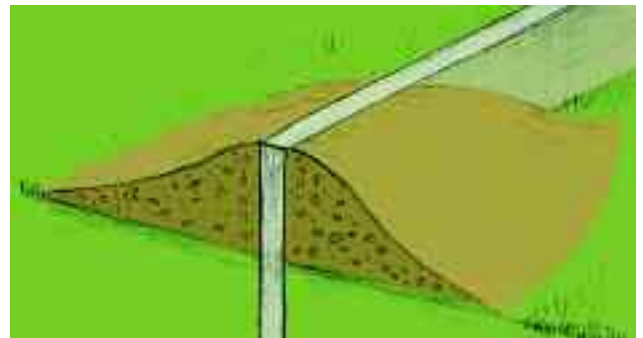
Rampes d'accès devant un mur de soutènement.
